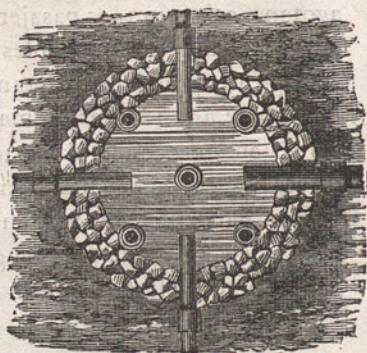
Plano de la puerta central de un avenado vertical de bóveda.
